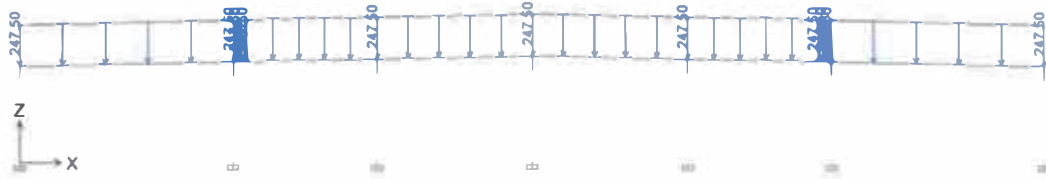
Aplicación de la Carga Viva al Sistema Estructural.
